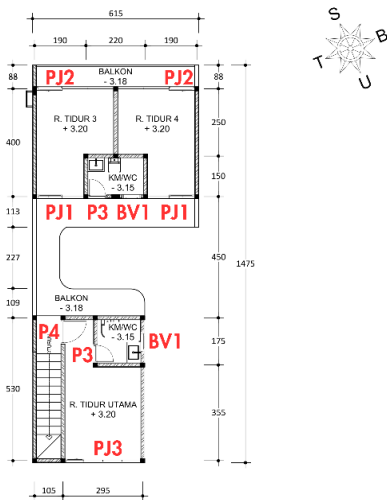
Denah Bukaam Pintu dan Jendela Kaca Lantai 1 Villa Amarta Dua Jogja (Sumber: Archira Architect, 2025)
